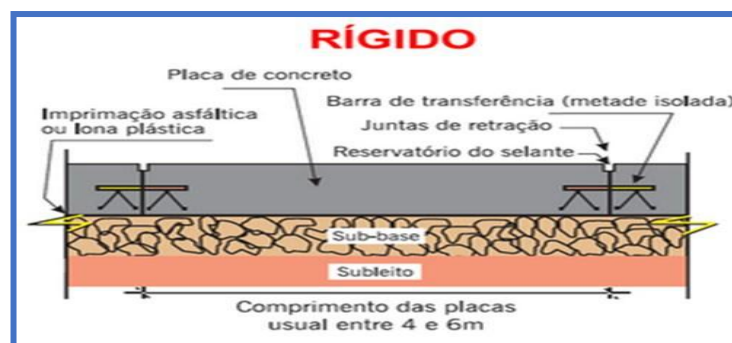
Ubicación transversal del Sistema Dowels en un Pavimento Rígido.
